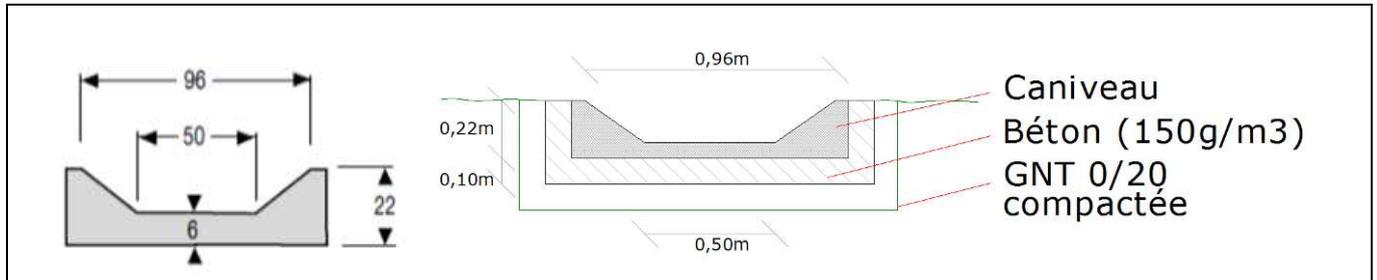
Coupe de principe sans échelle des caniveaux transversaux
